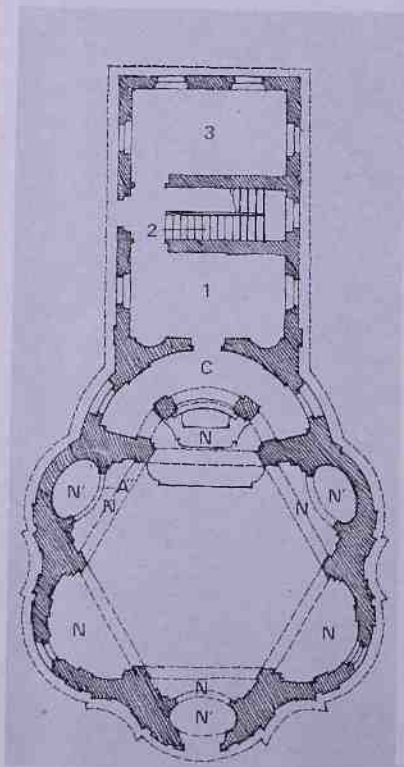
^{bis} - Pianta al piano terreno (rilievo).
